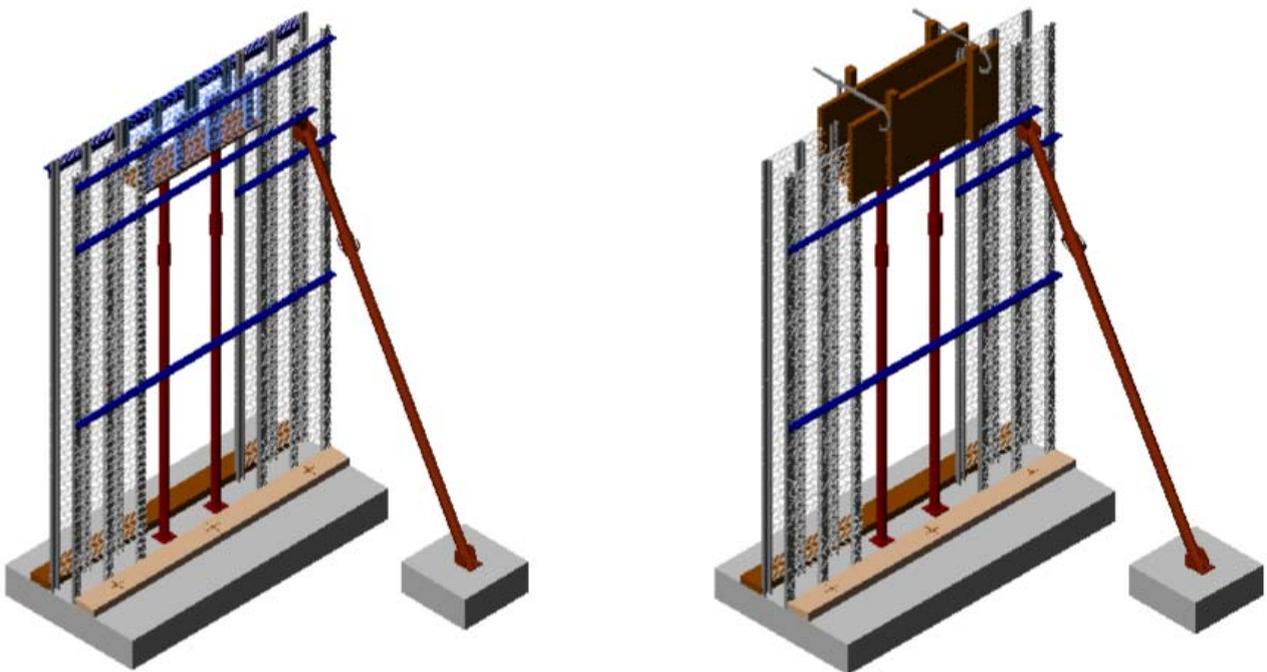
Recouvrement entre deux panneaux COFFOR
